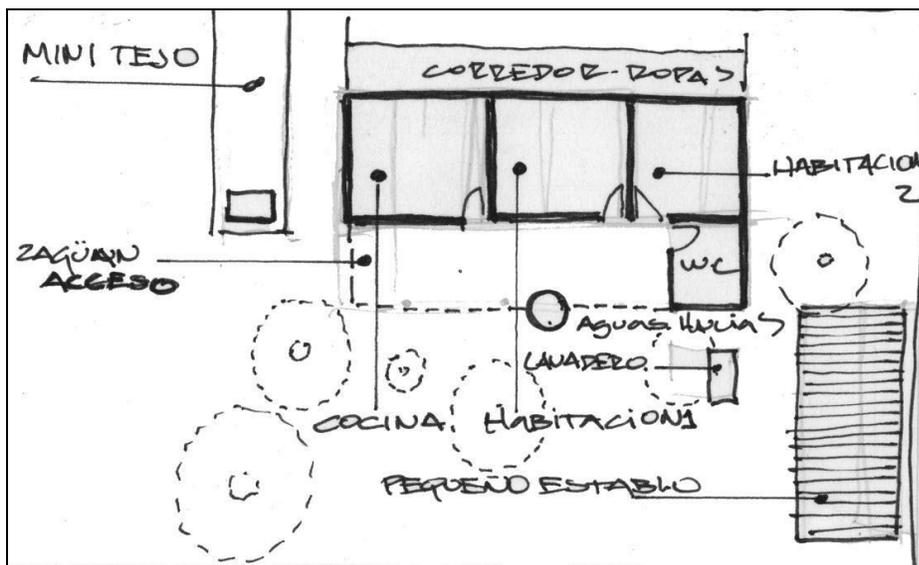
Croquis general de la vivienda de María y Javier. Fuente: Autor.
